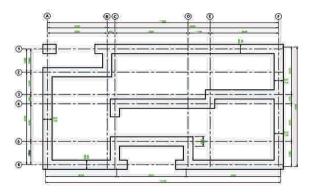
24: Plano de excavaciones de la vivienda prototipo.
